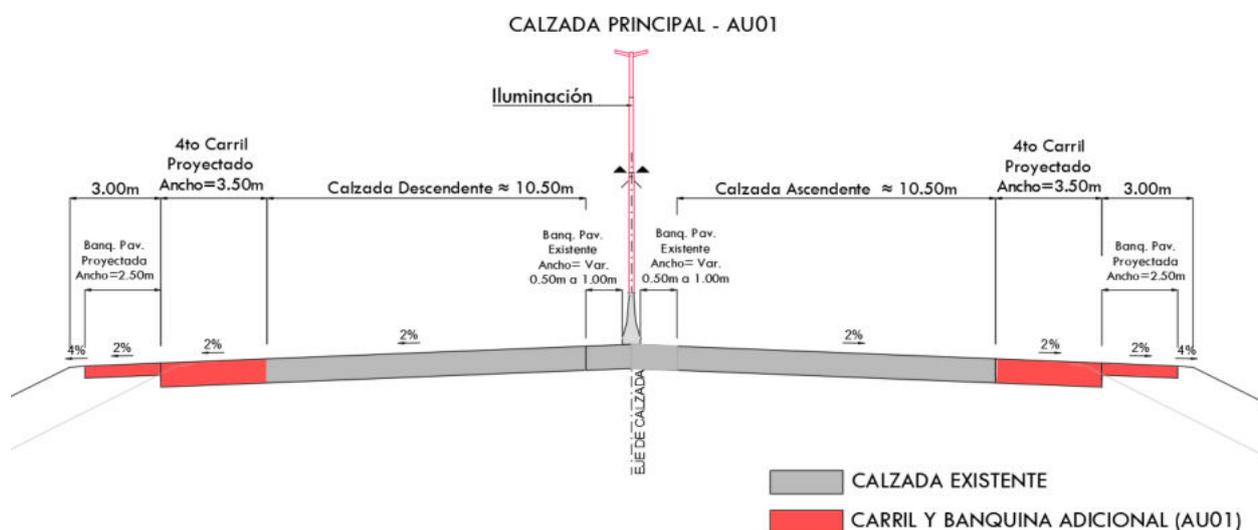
Perfil Transversal de Calzada Principal - Obra AU01
